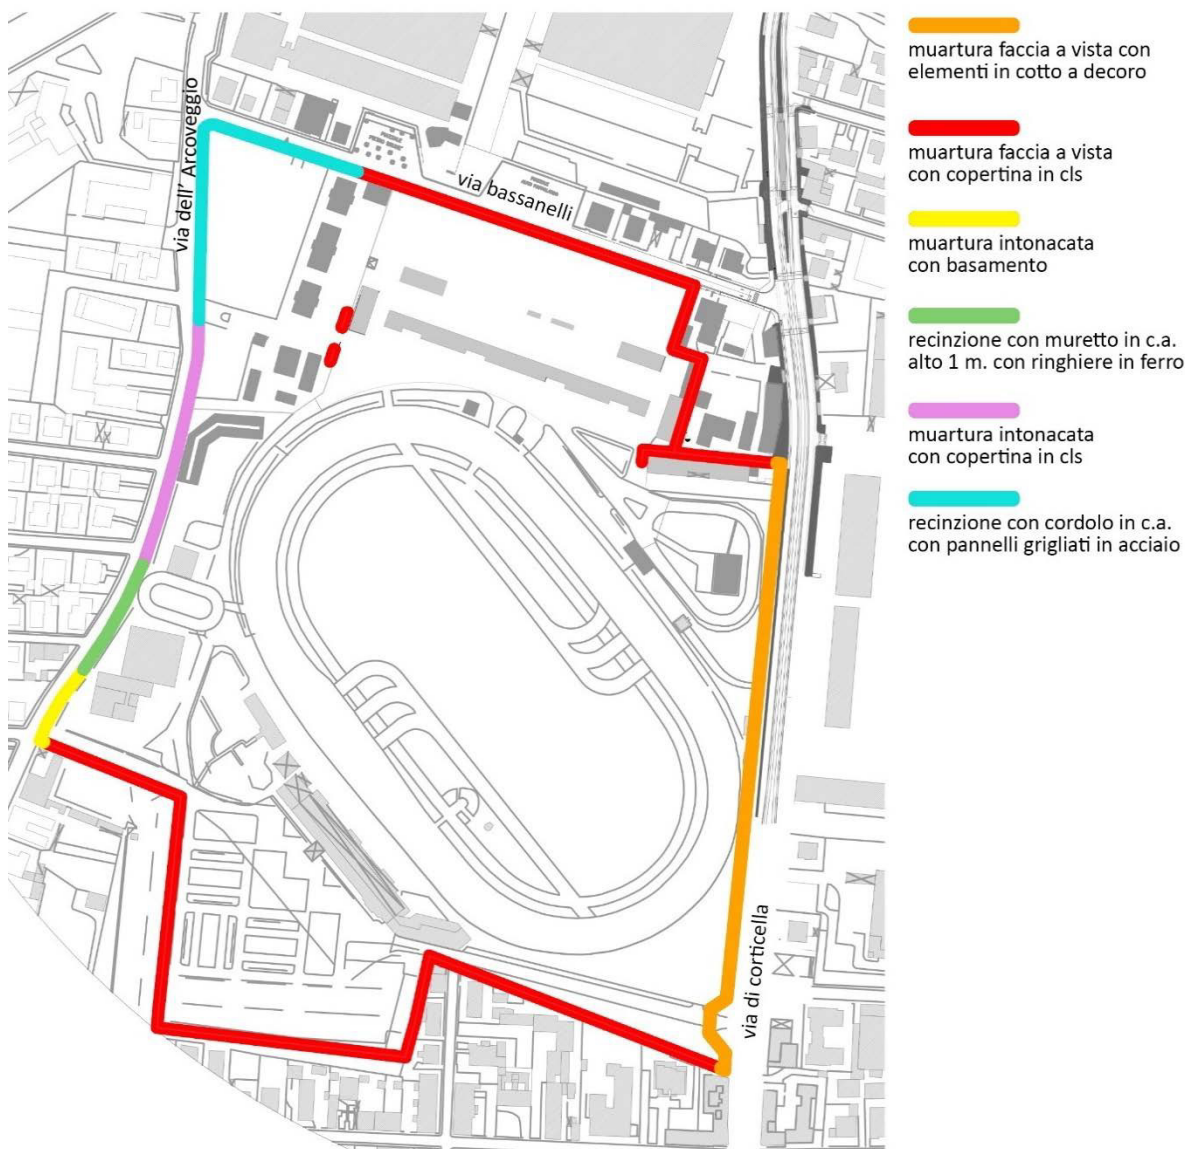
Schema planimetrico del Perimetro del Complesso
